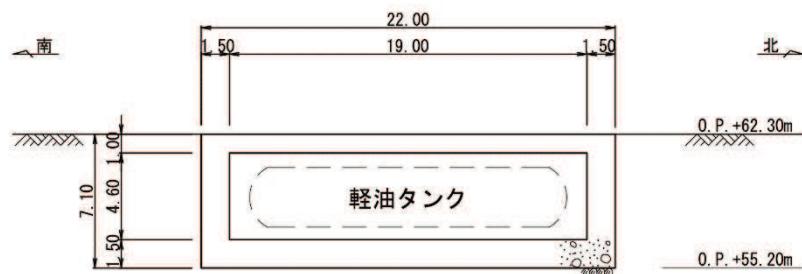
ガスタービン発電設備軽油タンク室断面図 (A-A断面)
